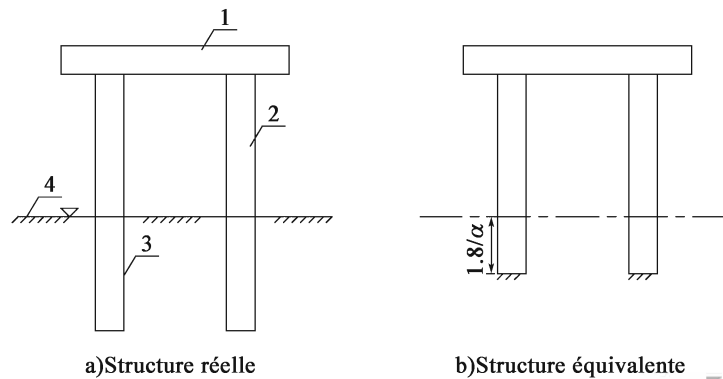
Modélisation de la fondation des chevêtres supportés par des piles-pieux
